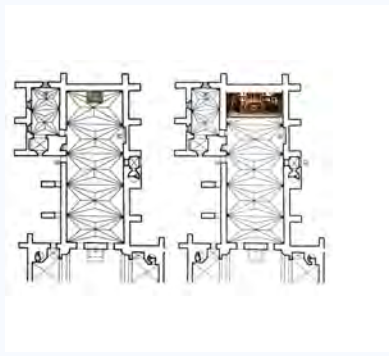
Grundriss des Presbyteriums mit Einzeichnung des Altars aus den Jahren 1504 und 1752.
